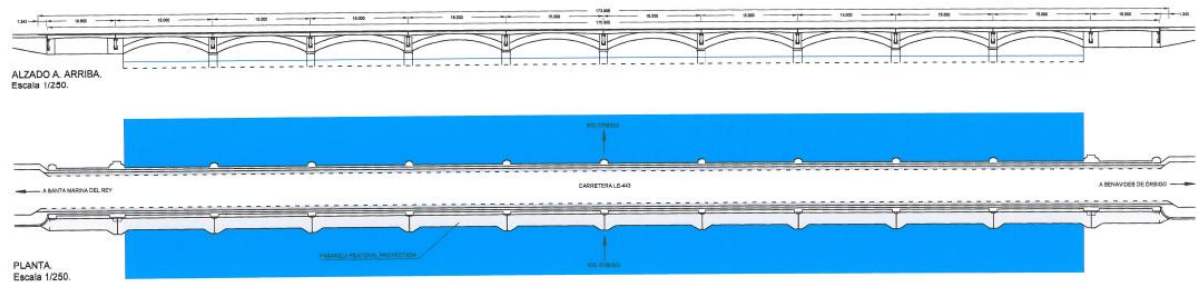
Planos de referencia. Alzado y planta del puente y pasarela peatonal.
